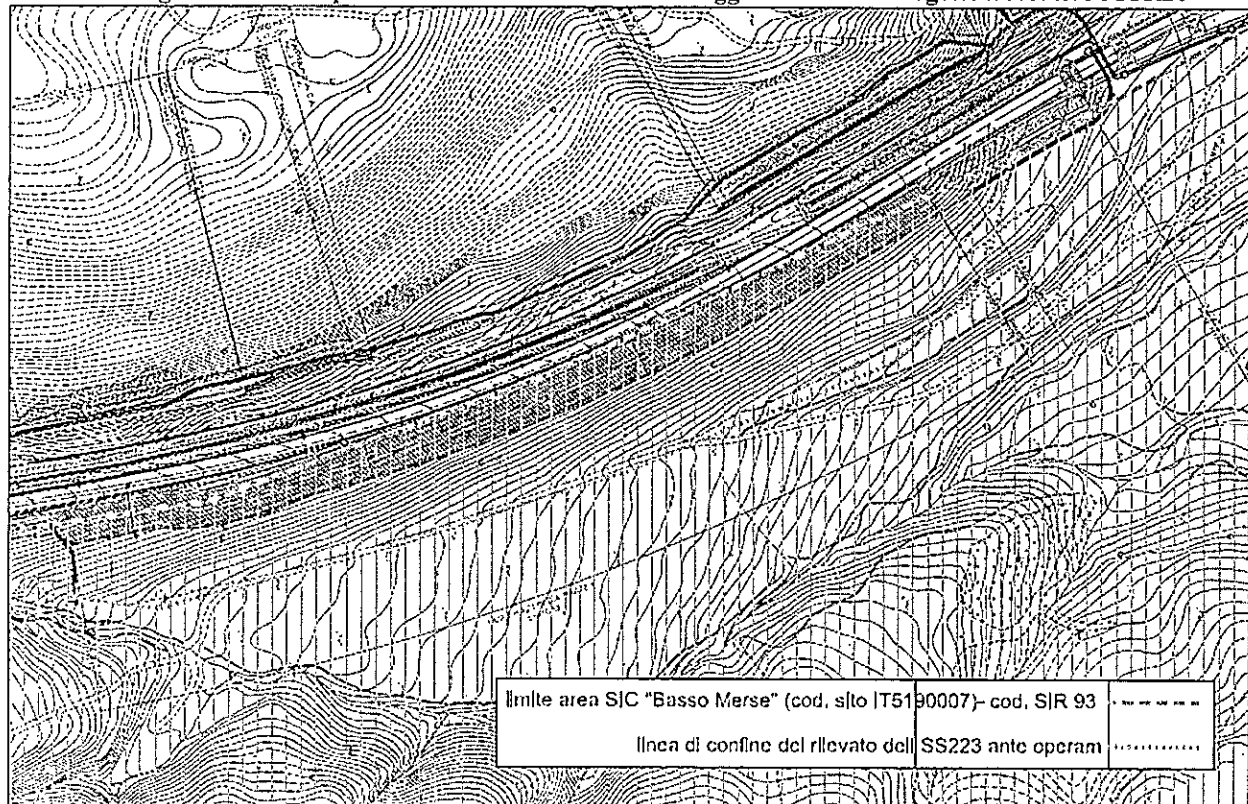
Stralcio planimetrico – Sistemazione carreggiata destra – Proposta di variante muro MU22
